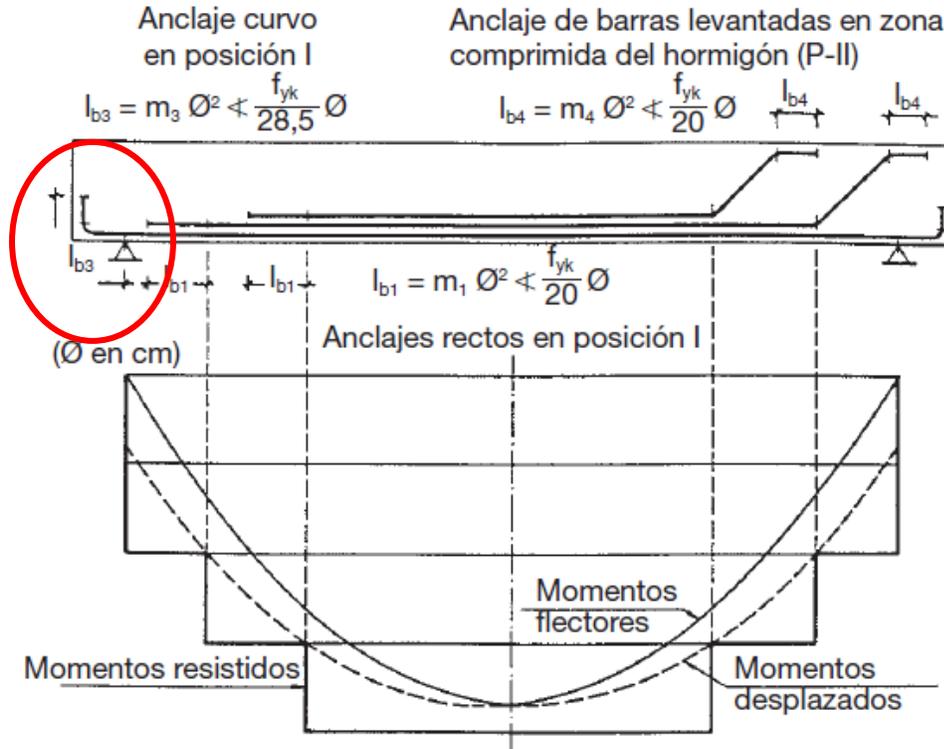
Ejemplo de anclaje de barras en viga simplemente apoyada
